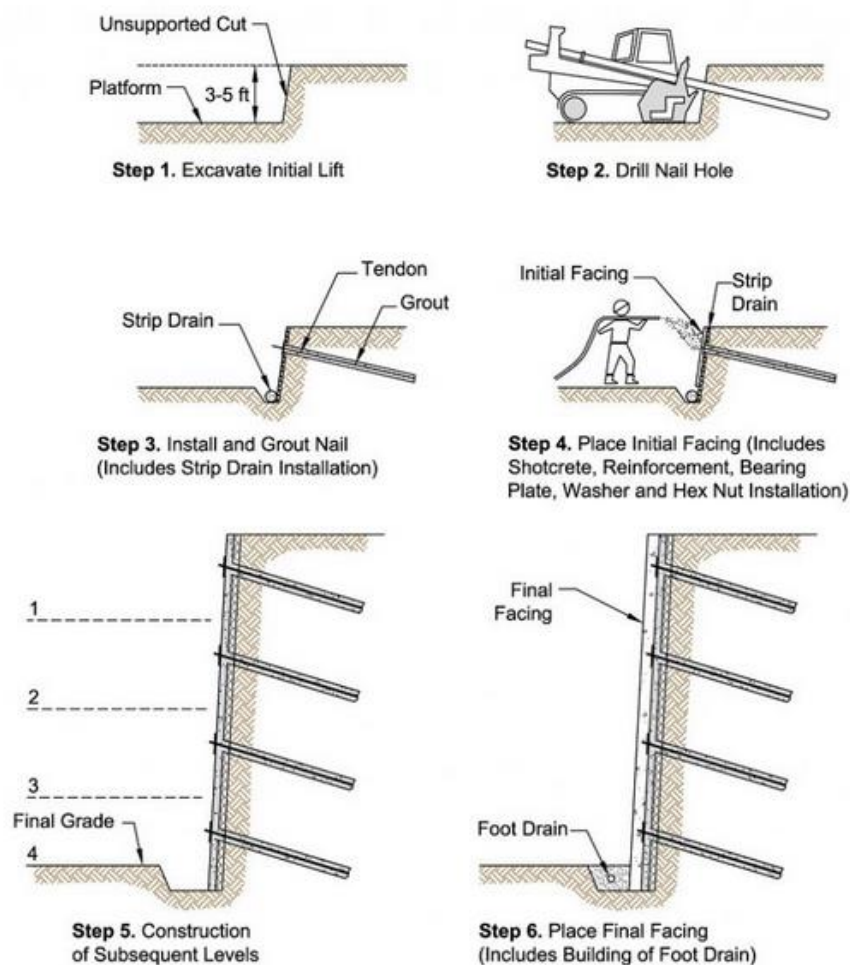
Procedimiento constructivo del Soil Nailing (Carlos A. Lazarte, Helen Robinson, Jesús E. Gómez, & Andrew Baxter, 2015).
